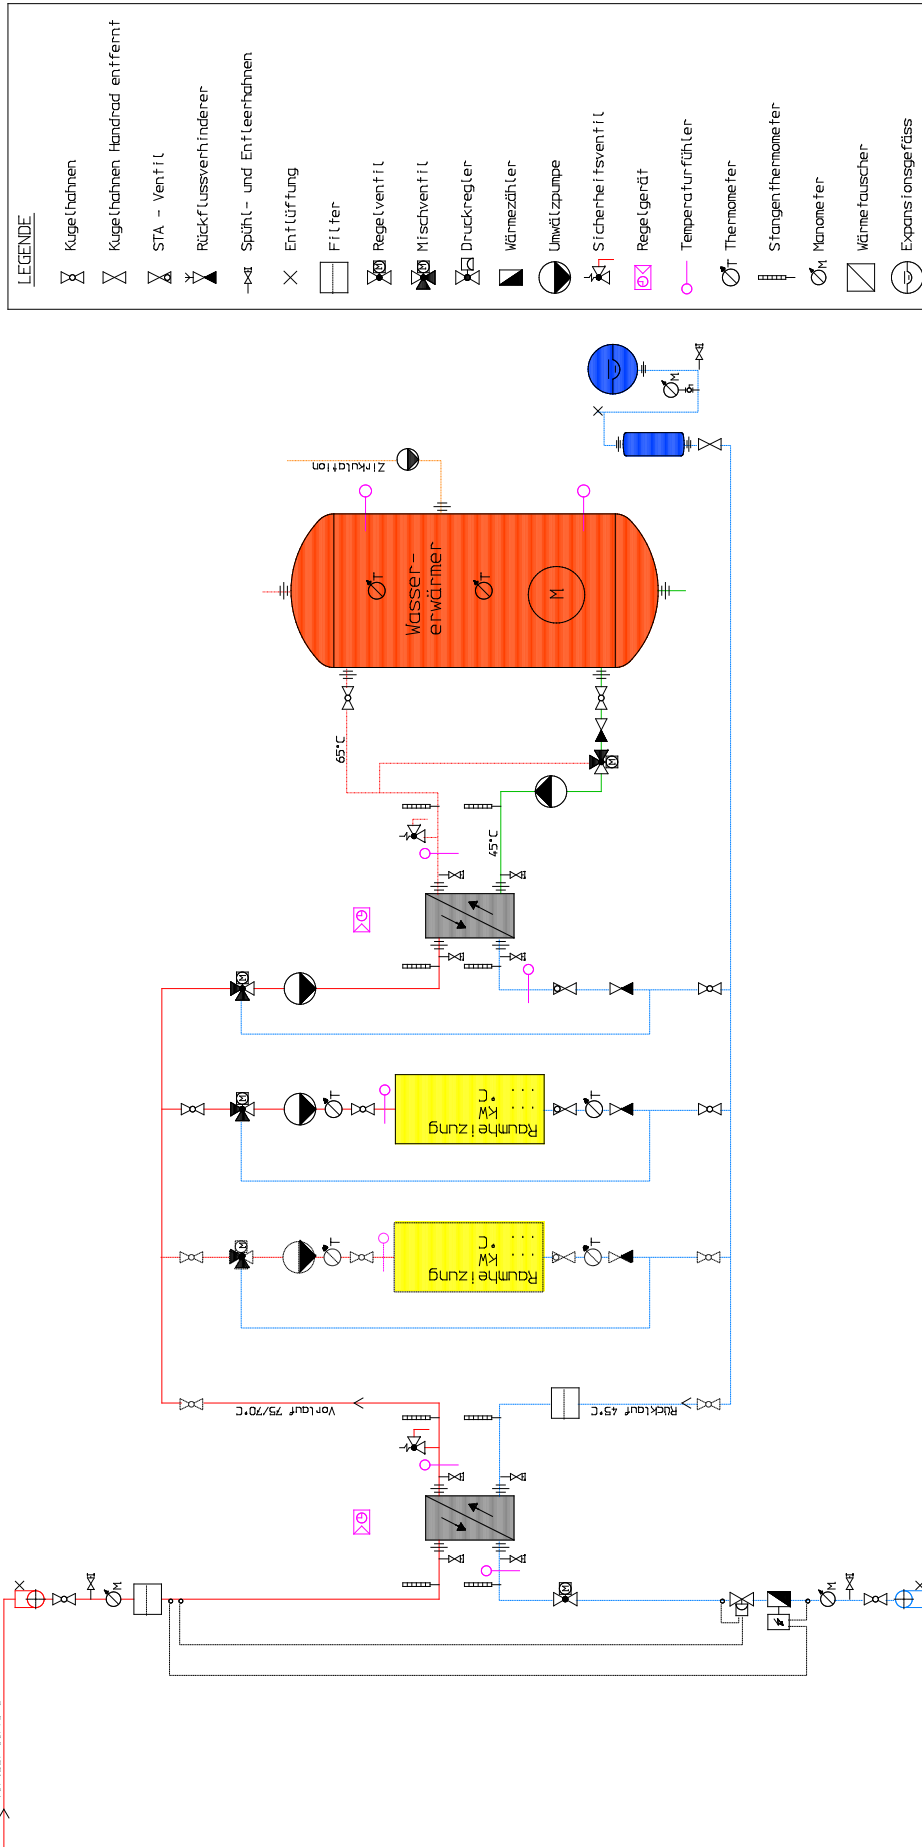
Fernwärme-Anschluss Heizung mit BWW-Ladung (Neuinstallation)
